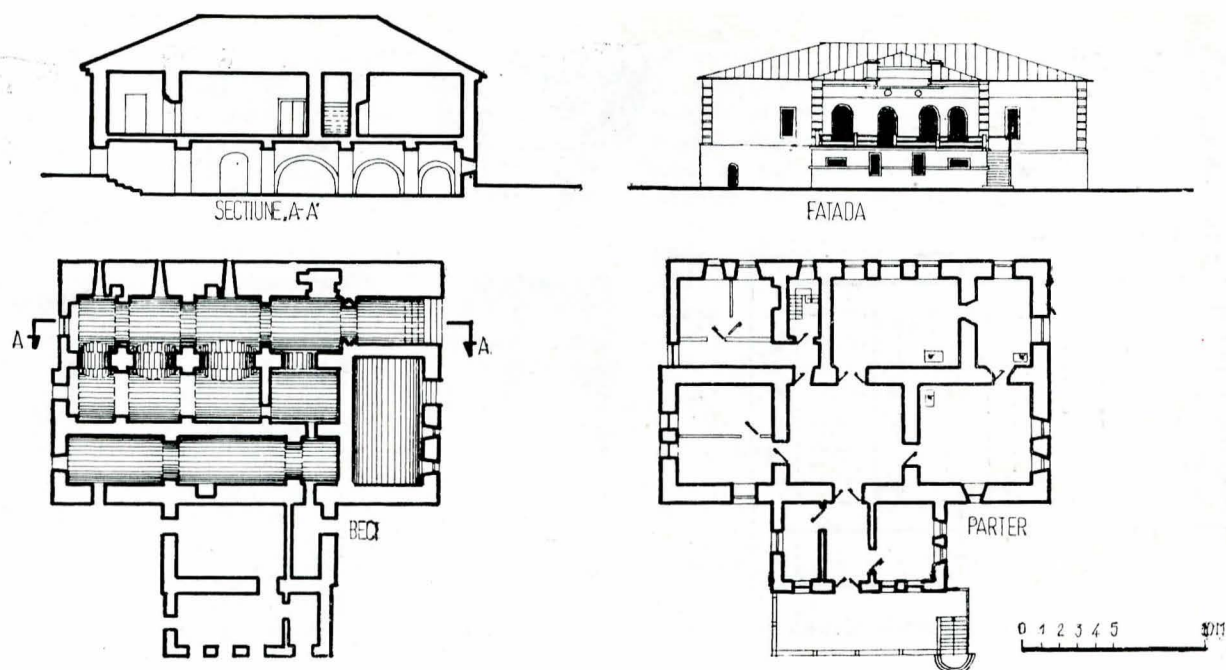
Conacul de la Drăgănești (plan beci, plan parter, secțiune longitudinală și fațada principală).
